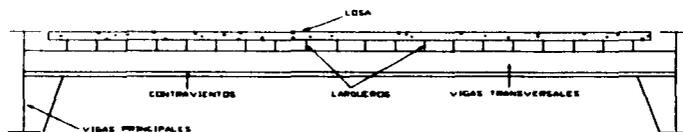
Puente antiguo de acero, 5 miembros actuando separadamente
